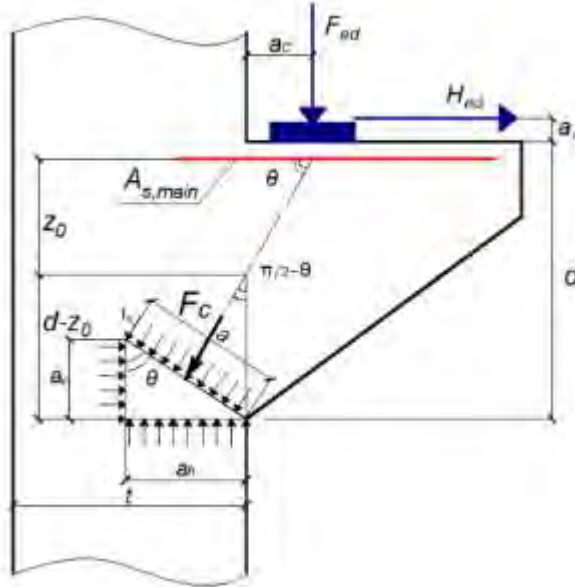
К определению угла наклона сжатого бетонного подкоса
